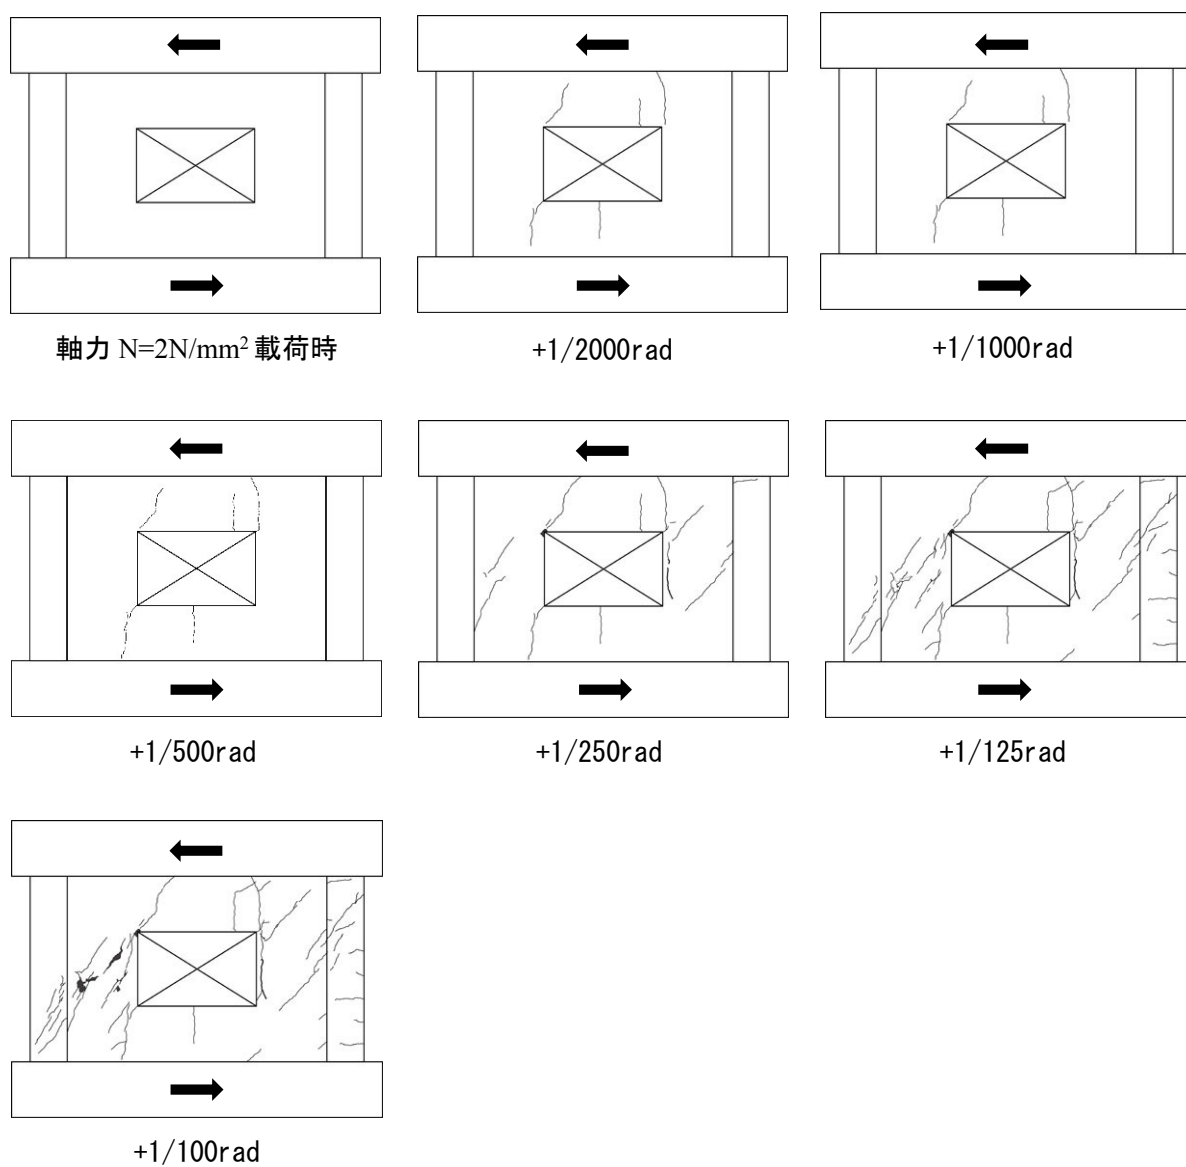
各層間変形角のひび割れ状況図 (F7-SWC-1.5)
